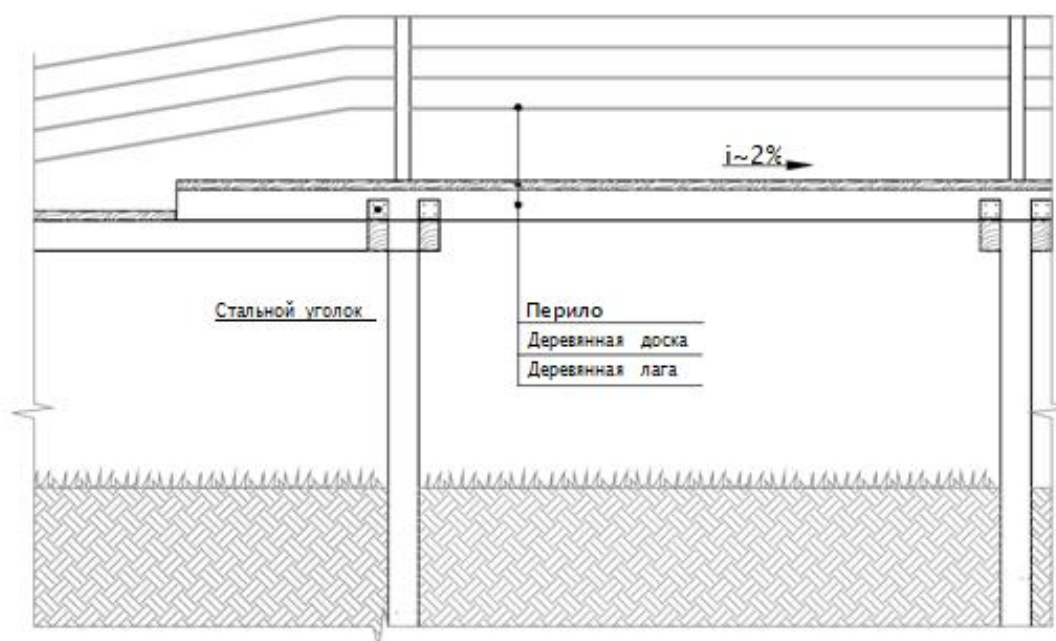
Схема устройства деревянного пандуса на сваях
